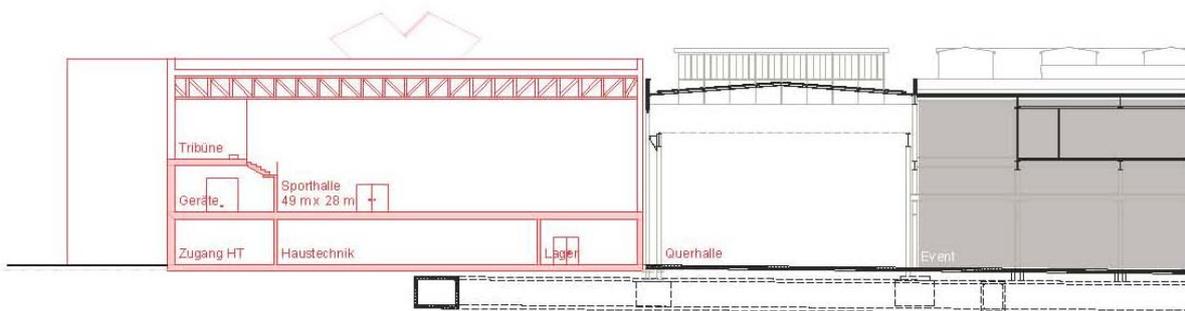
Querschnitt Dreifachsporthalle und Querhalle
